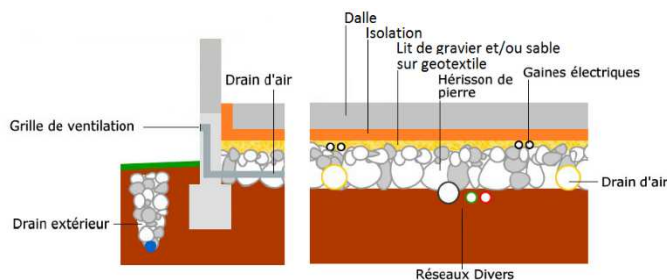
schéma technique dalle isolée sur hérisson ventilé
